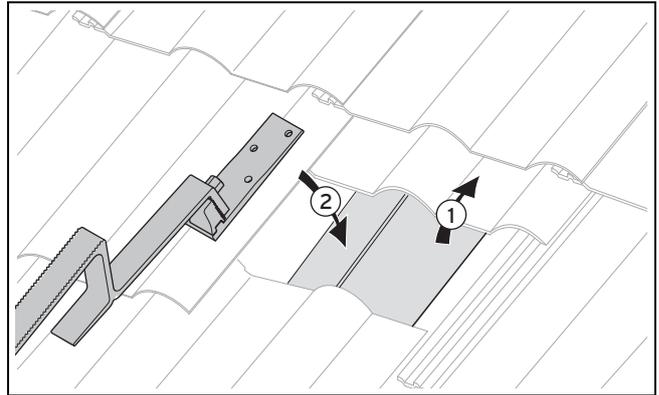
Dachsparren freilegen und Dachanker Typ P anlegen
